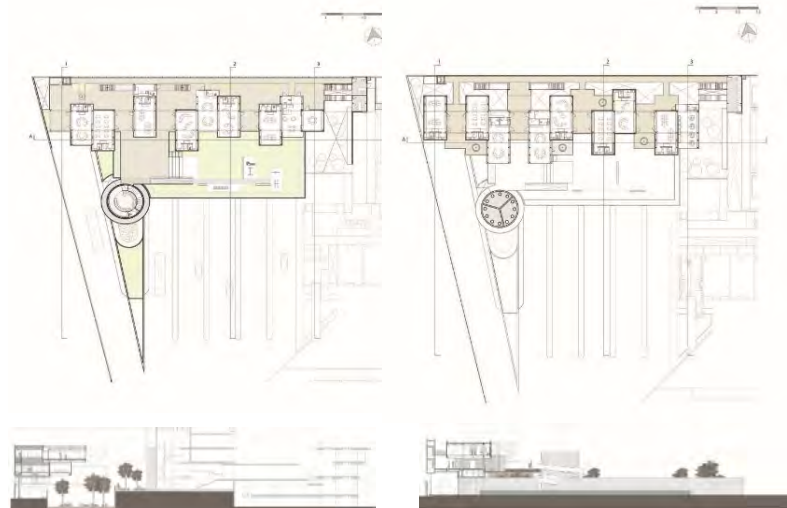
Planta baja, 2014 y Corte 2, 2014. (ArchDaily México, 2016)
